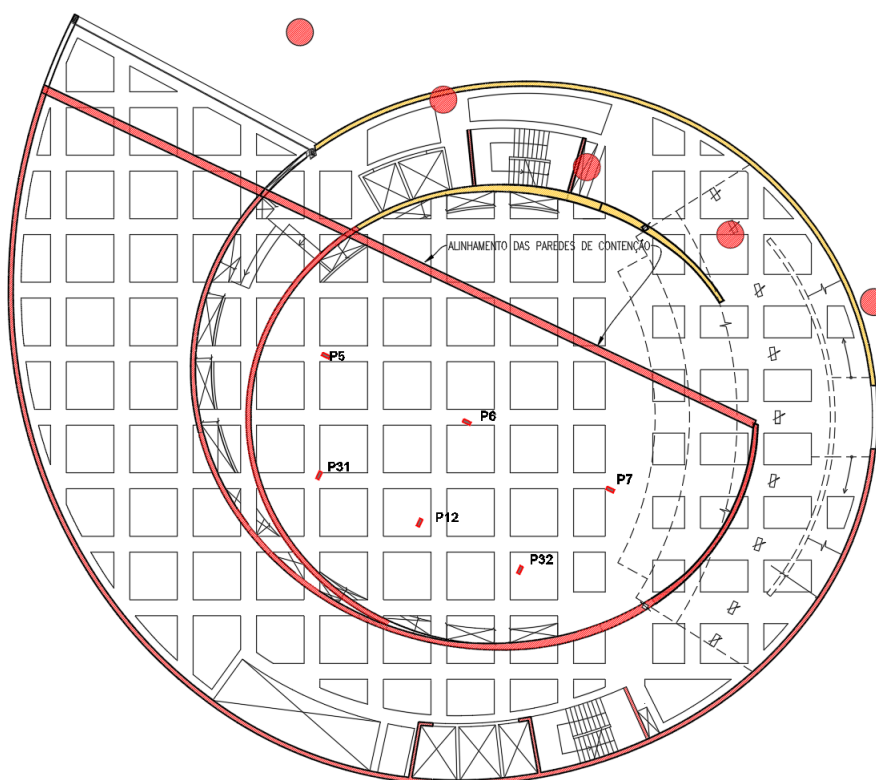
Alinhamentos de apoios disponíveis (assinalados a vermelho) para execução das lajes do piso 1, 2 e cobertura
